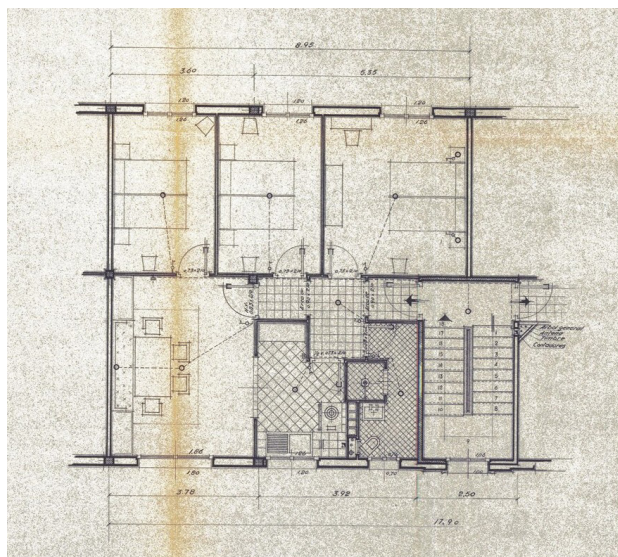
Distribución en planta del bloque C del barrio de San Ignacio de Loyola diseñado por Hilario Imaz, Germán Aguirre, y Luis Lorenzo Blanc. Bilbao, junio de 1944. Fuente: AGAPCAE. Fondo Vivienda. Sección Viviendas de Protección Oficial. Serie construcción de viviendas del INV y de la OSH. Expediente constructivo del Grupo San Ignacio de Loyola de Bilbao, 1ª fase. Caja: EBCIO-00006. Signatura: G-140-1.
